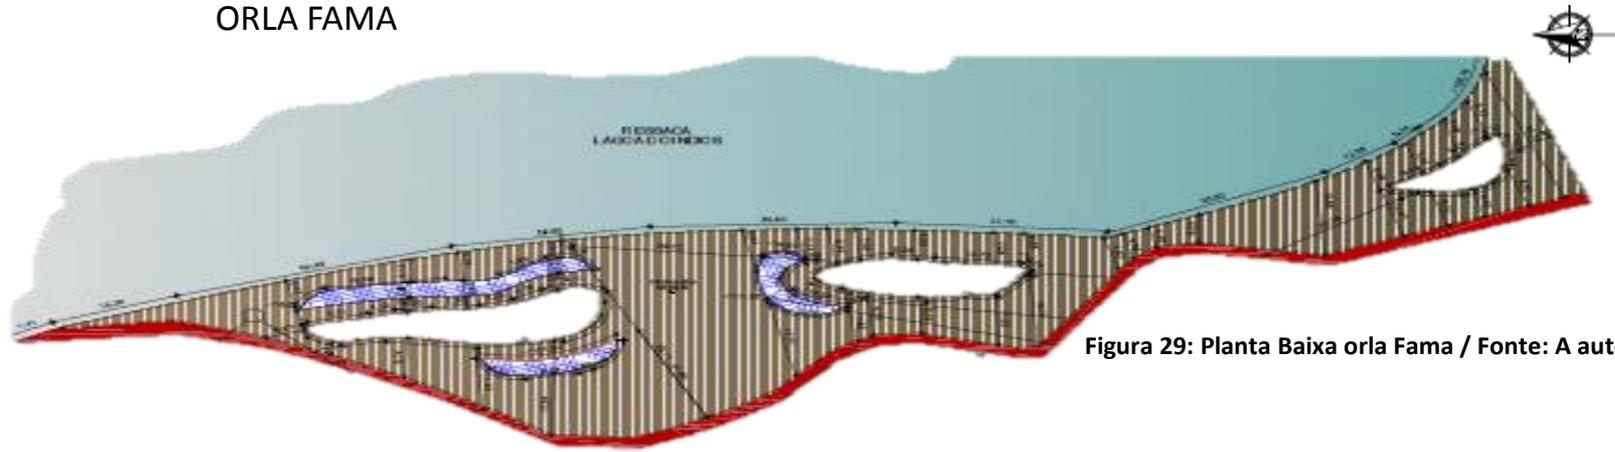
Planta Baixa orla Fama / Fonte: A autora, 2017.
